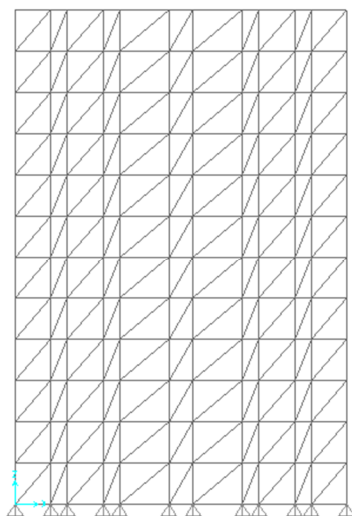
Configuração dos Planos de Contraventamento Vertical Com Elementos de Contraventamento Pequenos
